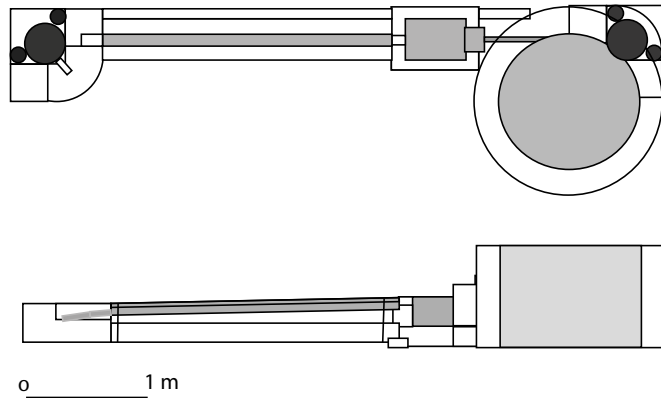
Planimetría y detalles de la pileta y del canal que desagua al exterior.
